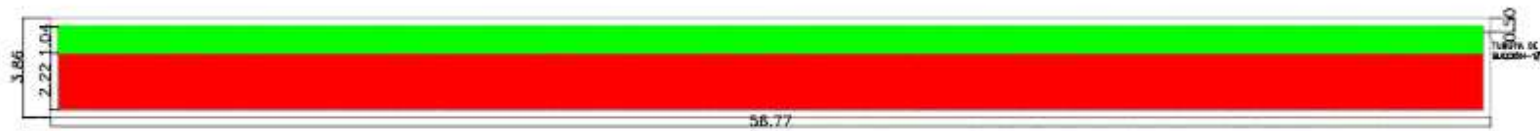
Vista en planta Drenaje sostenible Empresa manufacturera de embragues
